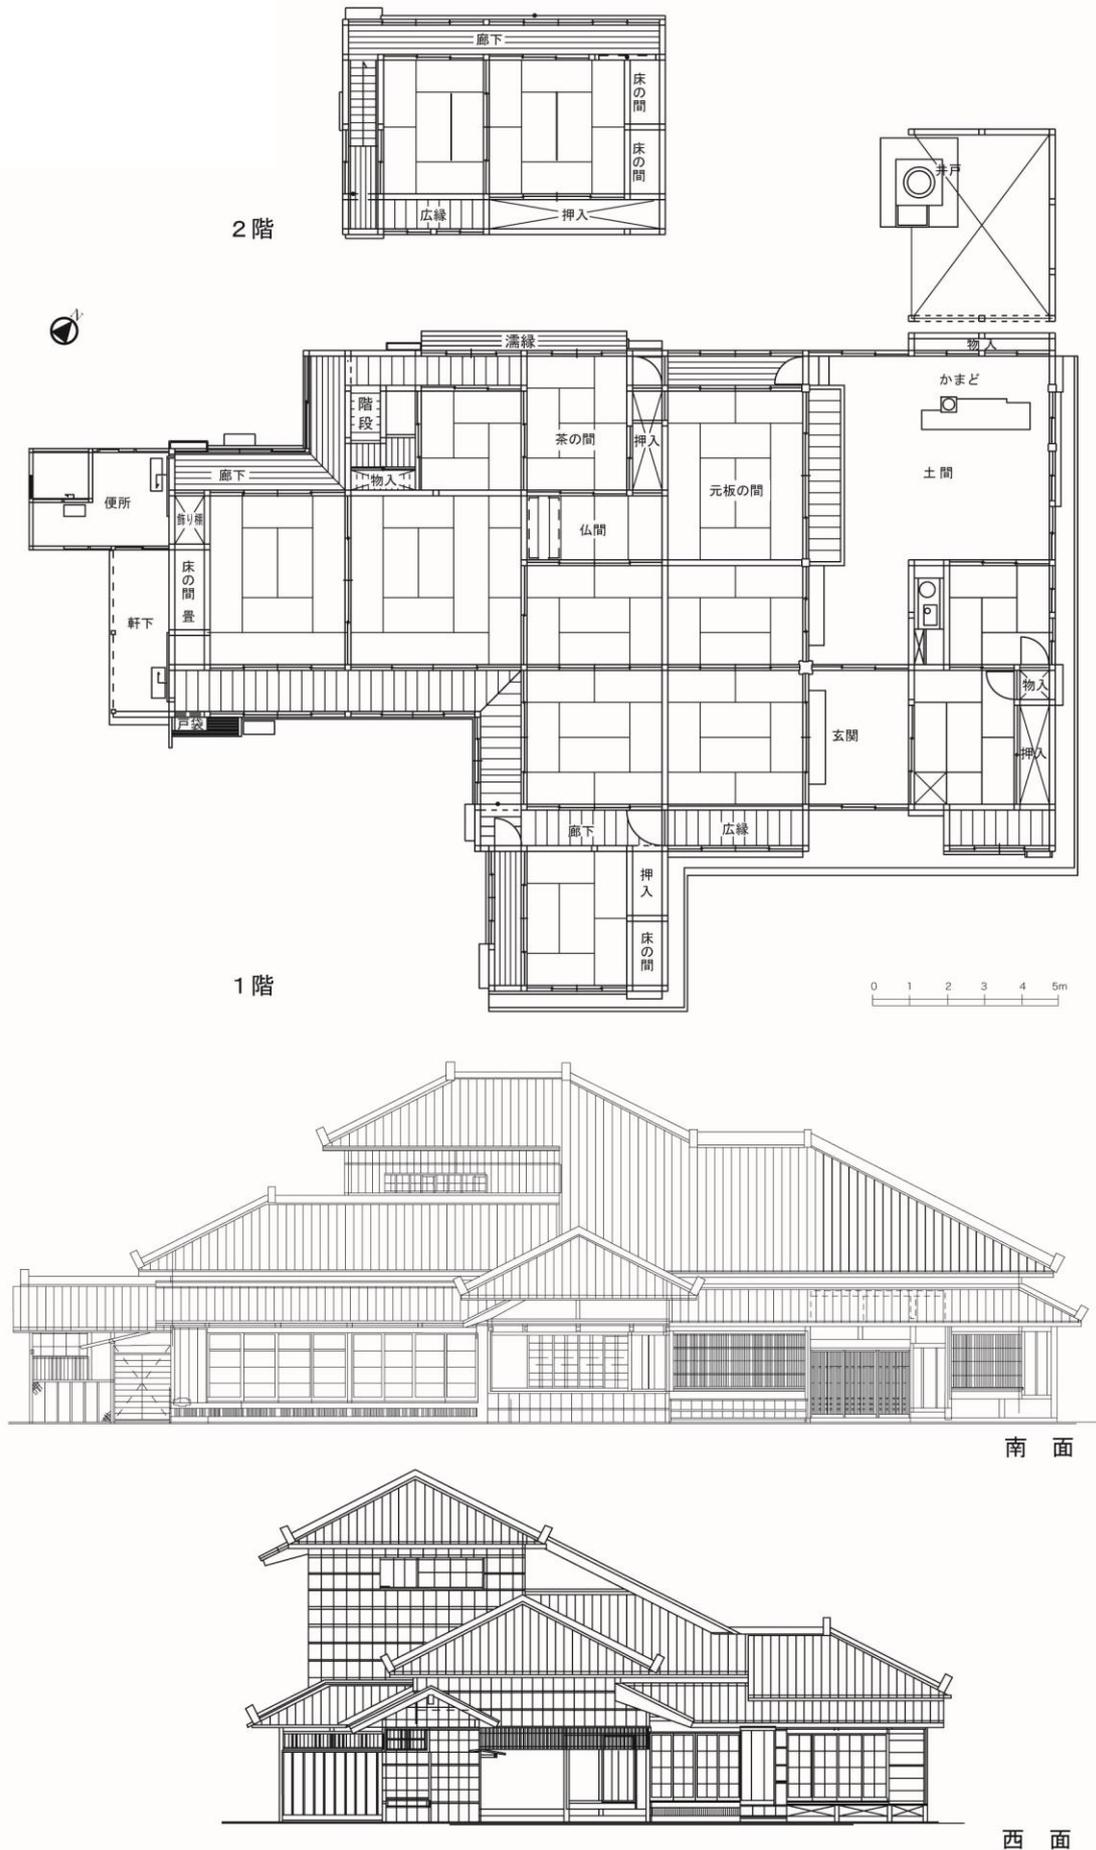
旧桜井家住宅（島田市博物館分館）平面・立面図
